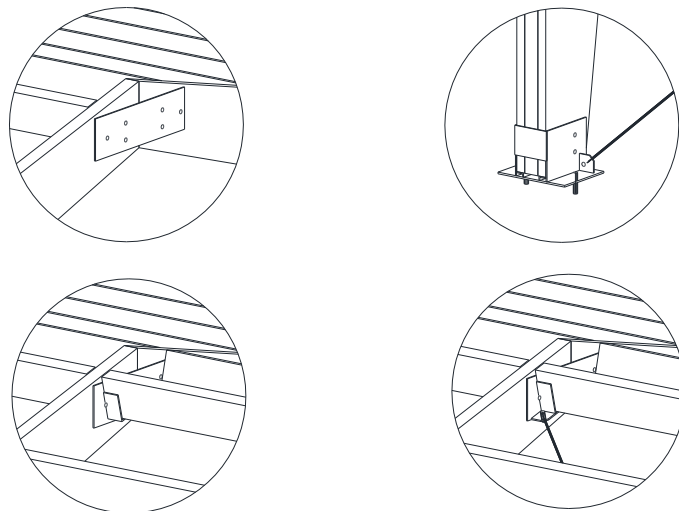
Pormenores das ligações metálicas entre elementos de madeira [Adaptado (Jular, 2018)].
